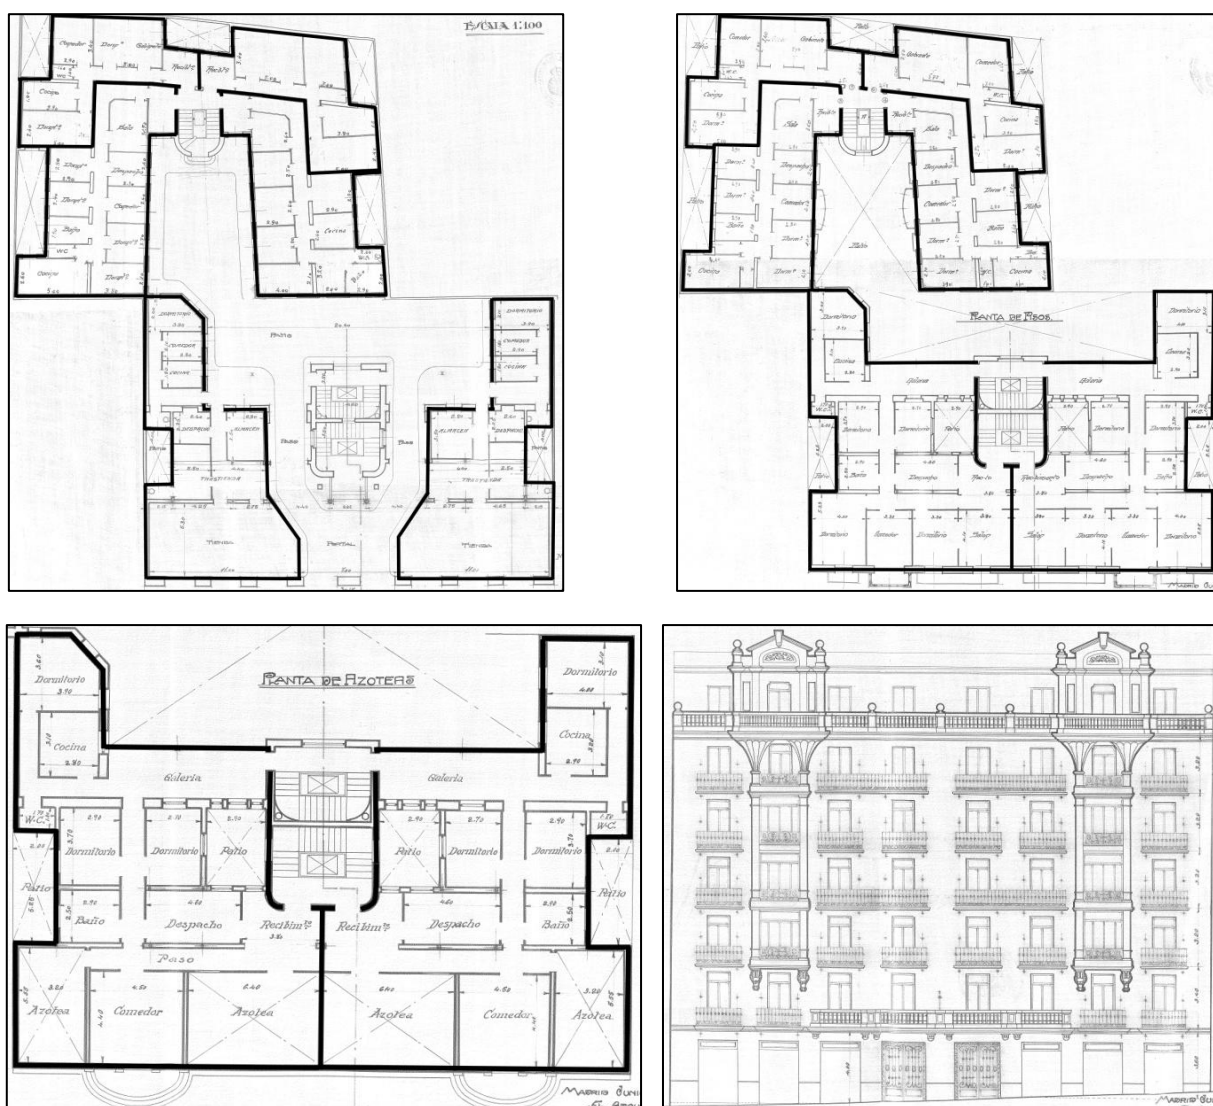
De izquierda a derecha, planos de la planta baja, pisos, azotea y fachada del inmueble del nº 41 (en la actualidad es el nº 43) de la calle Claudio Coello, edificado por Urbano Peña Chávarri entre 1925 y 1928. Escala 1:100. AVM, Secretaría, signatura 25-260-11.
